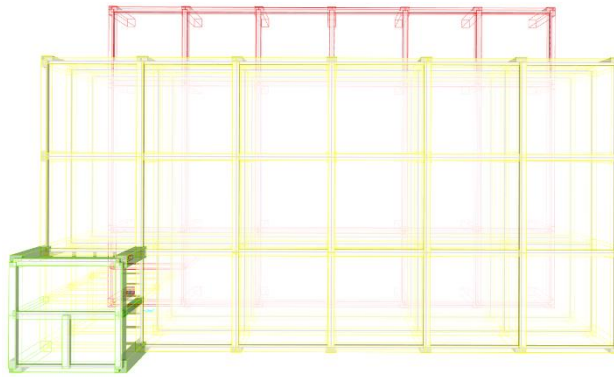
Denah Model Struktur Rumah Sakit L4
